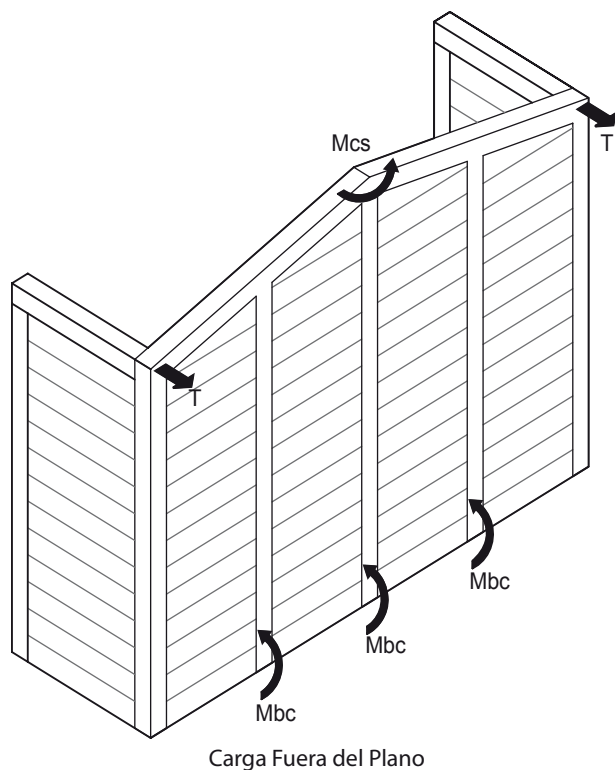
Simplificación del sistema estructural de los modelos bajo cargas perpendiculares a su plano.
